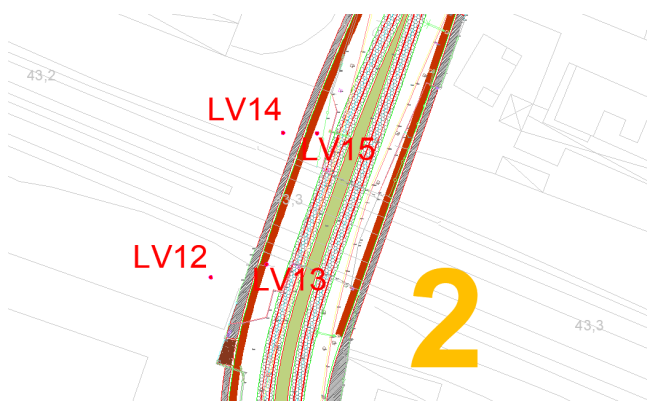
dettaglio planimetrico con il posizionamento dei carotaggi LV12-15
